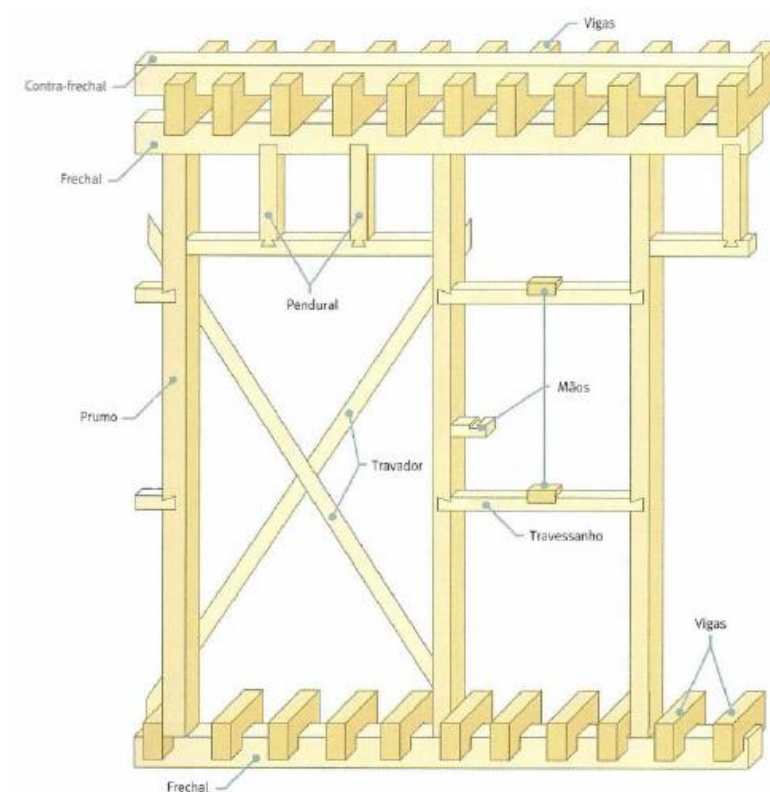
Estrutura de madeira nas paredes exteriores. [7]
